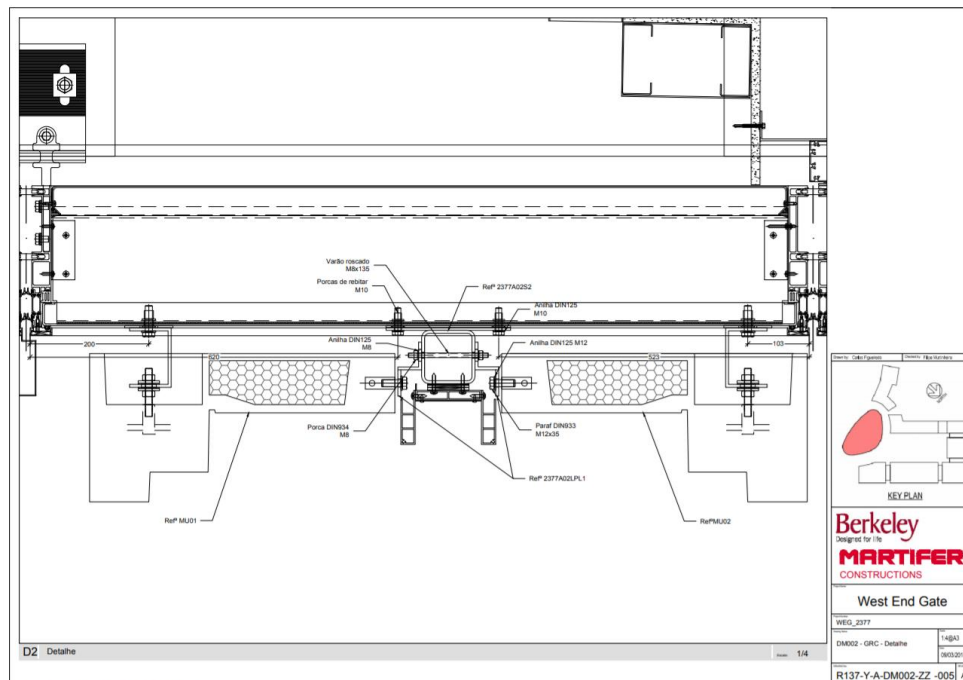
Desenho de montagem: GRC (Cortesia: Martifer).
